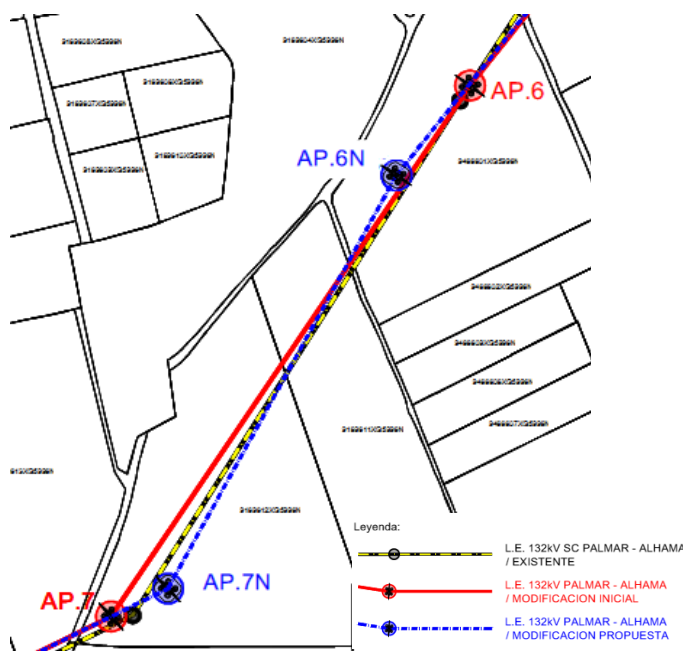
Plano de la modificación propuesta por el promotor, informada favorablemente por Ayuntamiento de Murcia. Fuente: Proyecto de Modificación al Proyecto de ejecución línea eléctrica a 132 kV, cuádruple circuito El Palmar – Alhama L/132 paso de s.c. a c.c. entre Ap.3 y Ap.24 reforma Ap.6 y Ap.7.
